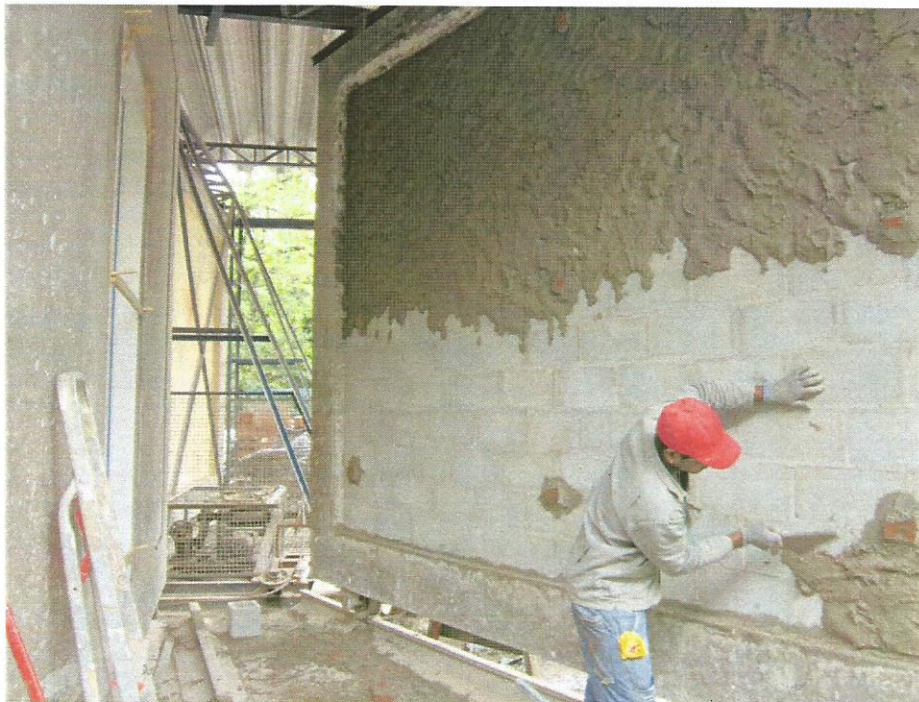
Revestimento em argamassa da parede de blocos de concreto
